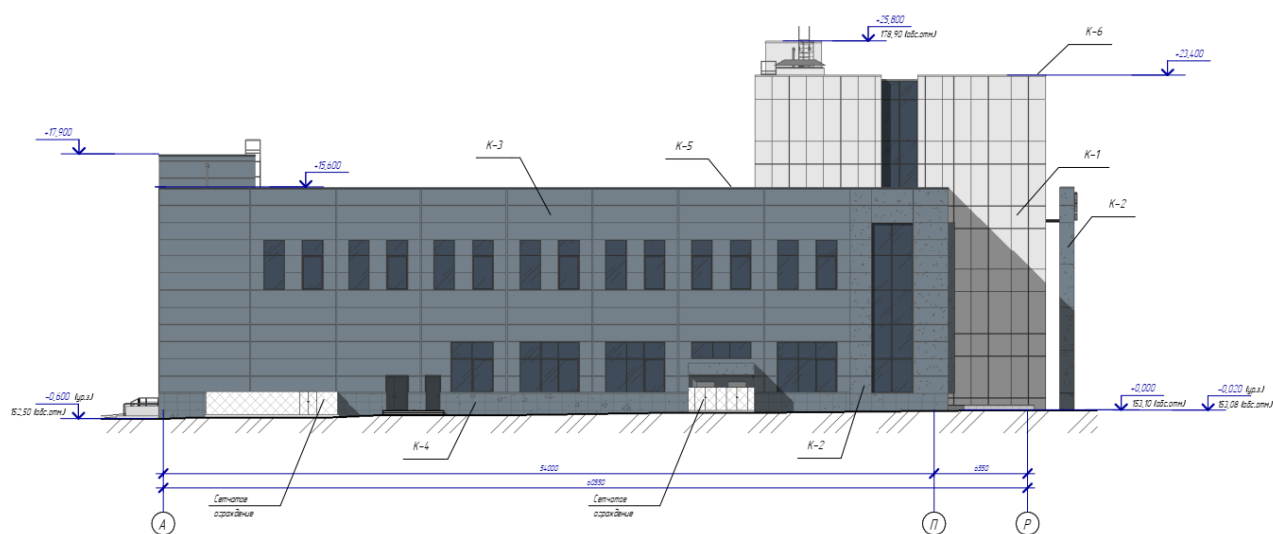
Схема фасада по оси А-Р (вид сбоку)
